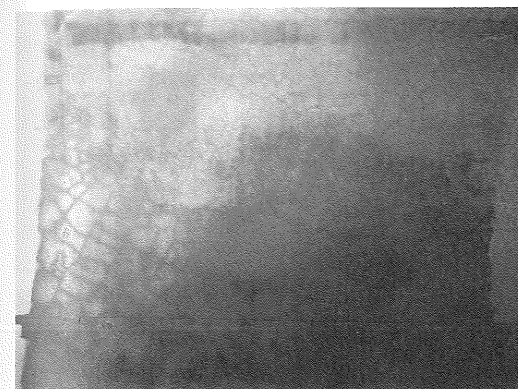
亀甲状の微細ひび割れ(湿潤状態で撮影)
